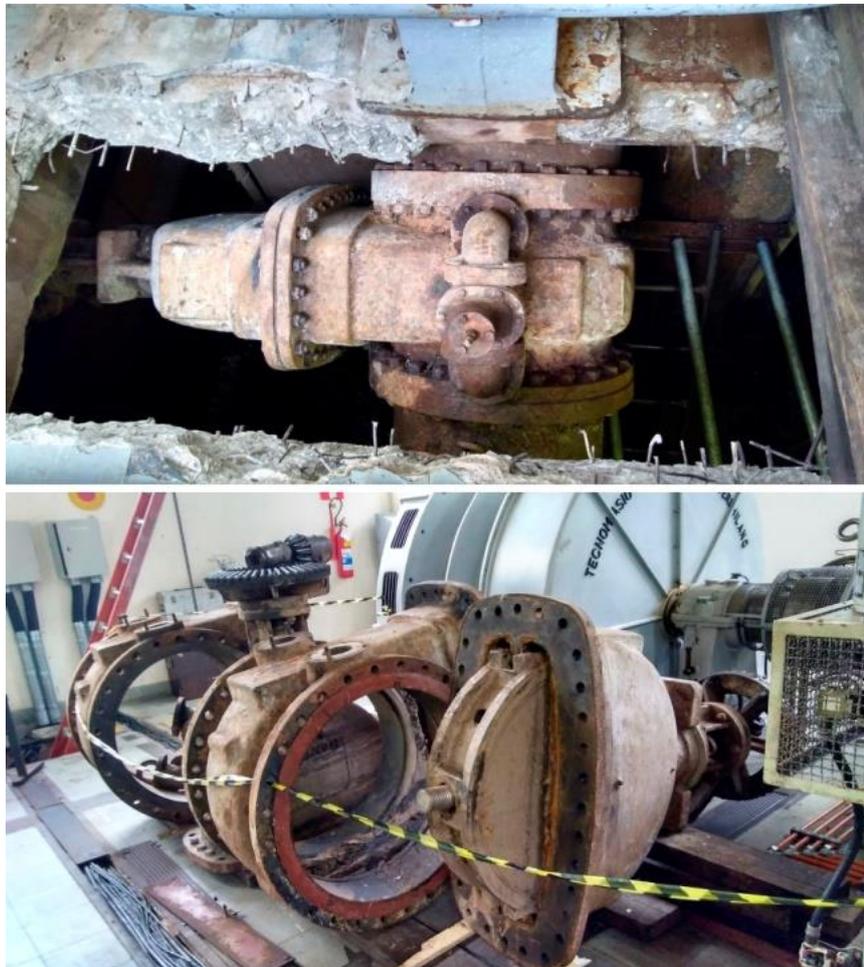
Piso recortado para acesso e troca da válvula de adução acima; abaixo válvulas gaveta antigas retiradas do conduto. Fonte: o autor.
